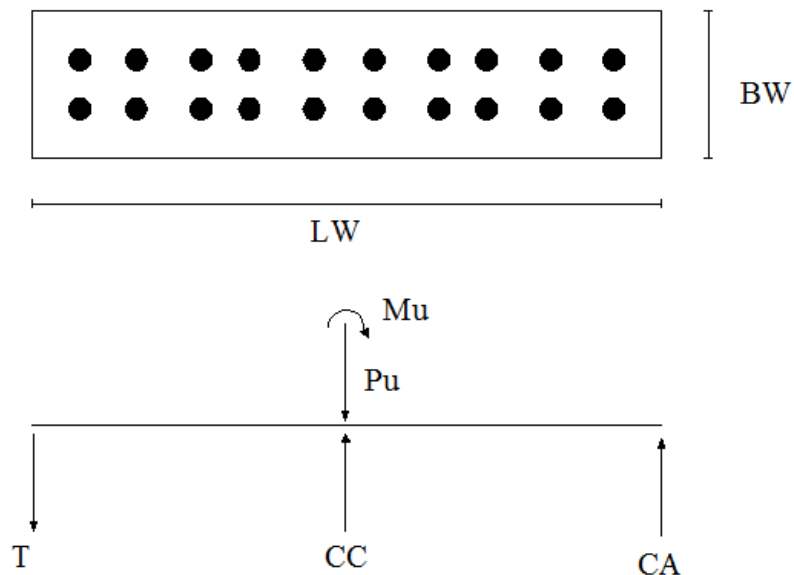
Diagrama de Fuerzas Simplificado para Muro Rectangular.
